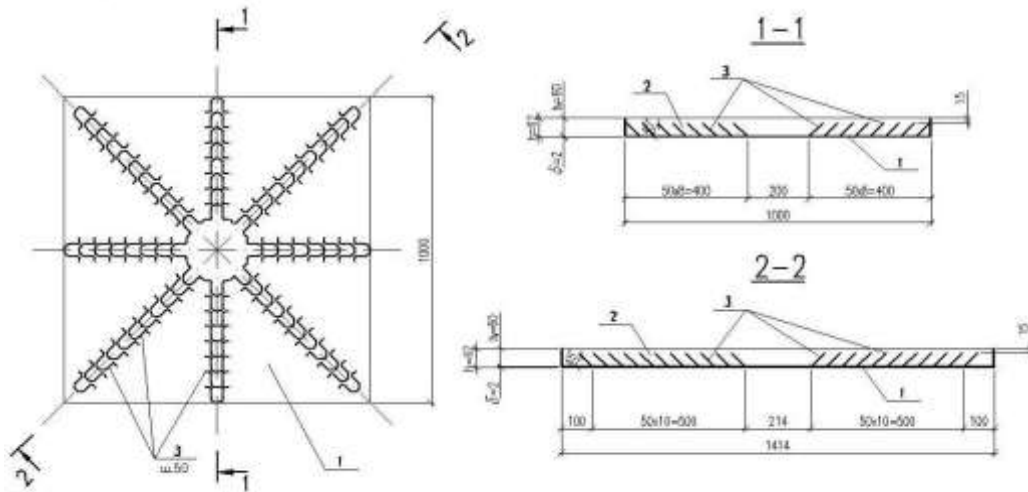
Конструкція сталобетонних плит ПШ50-1, ПШ50-2, ПЗ50-1, ПЗ50-2: 1 – металевий лист, 2 – бетон, 3 – петльові анкери
